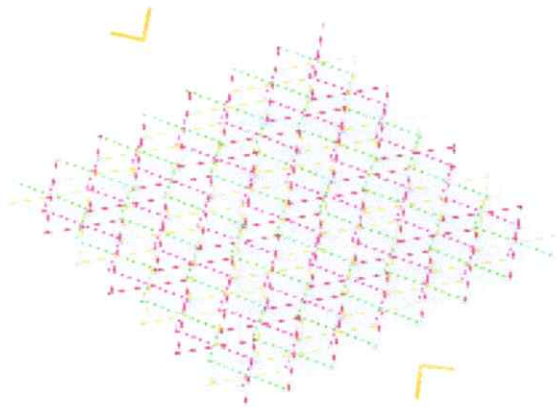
Barras articuladas según dirección de plegado. Fuente: Elaborado por el autor.
